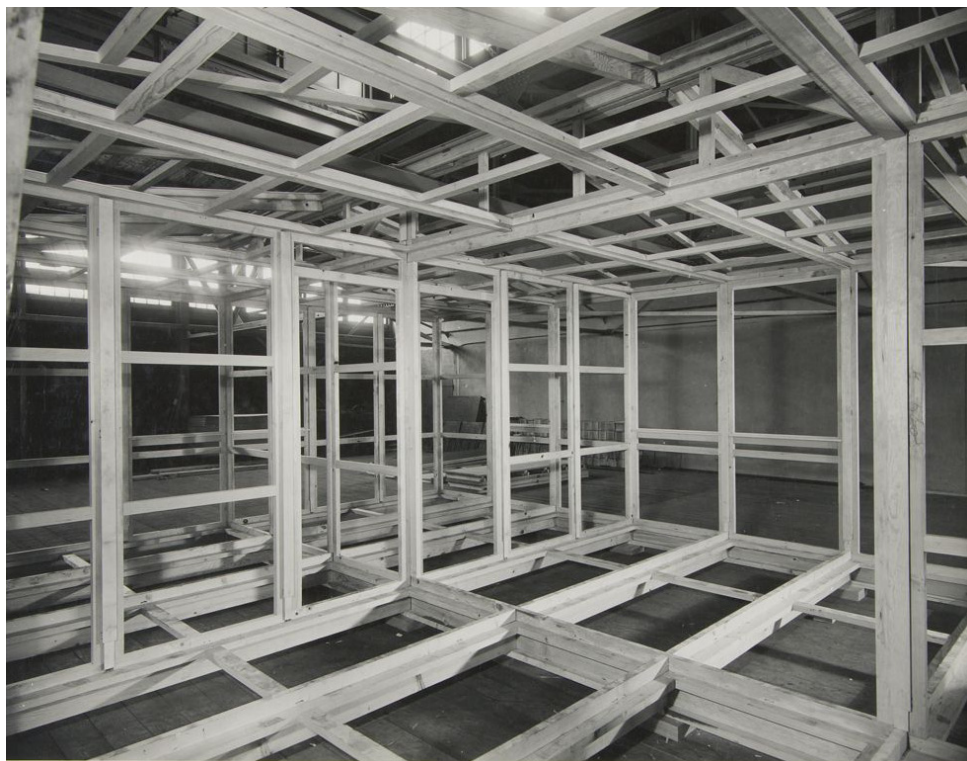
Detalle de construcción, Packaged house, vivienda prototipo, 1942
